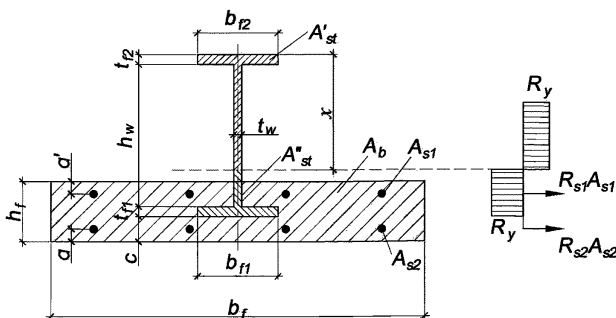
Случай, когда нейтральная ось пересекает стенку стального профиля жесткой арматуры в комбинированной балке с опиранием железобетонной плиты на нижний пояс
